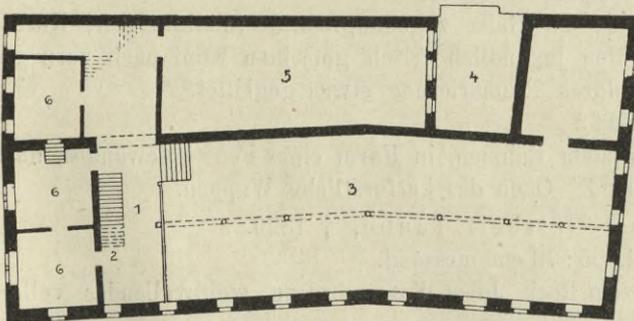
Grundriß des 1882 abgebrochenen Gewandhauses. Obergeschoss.
